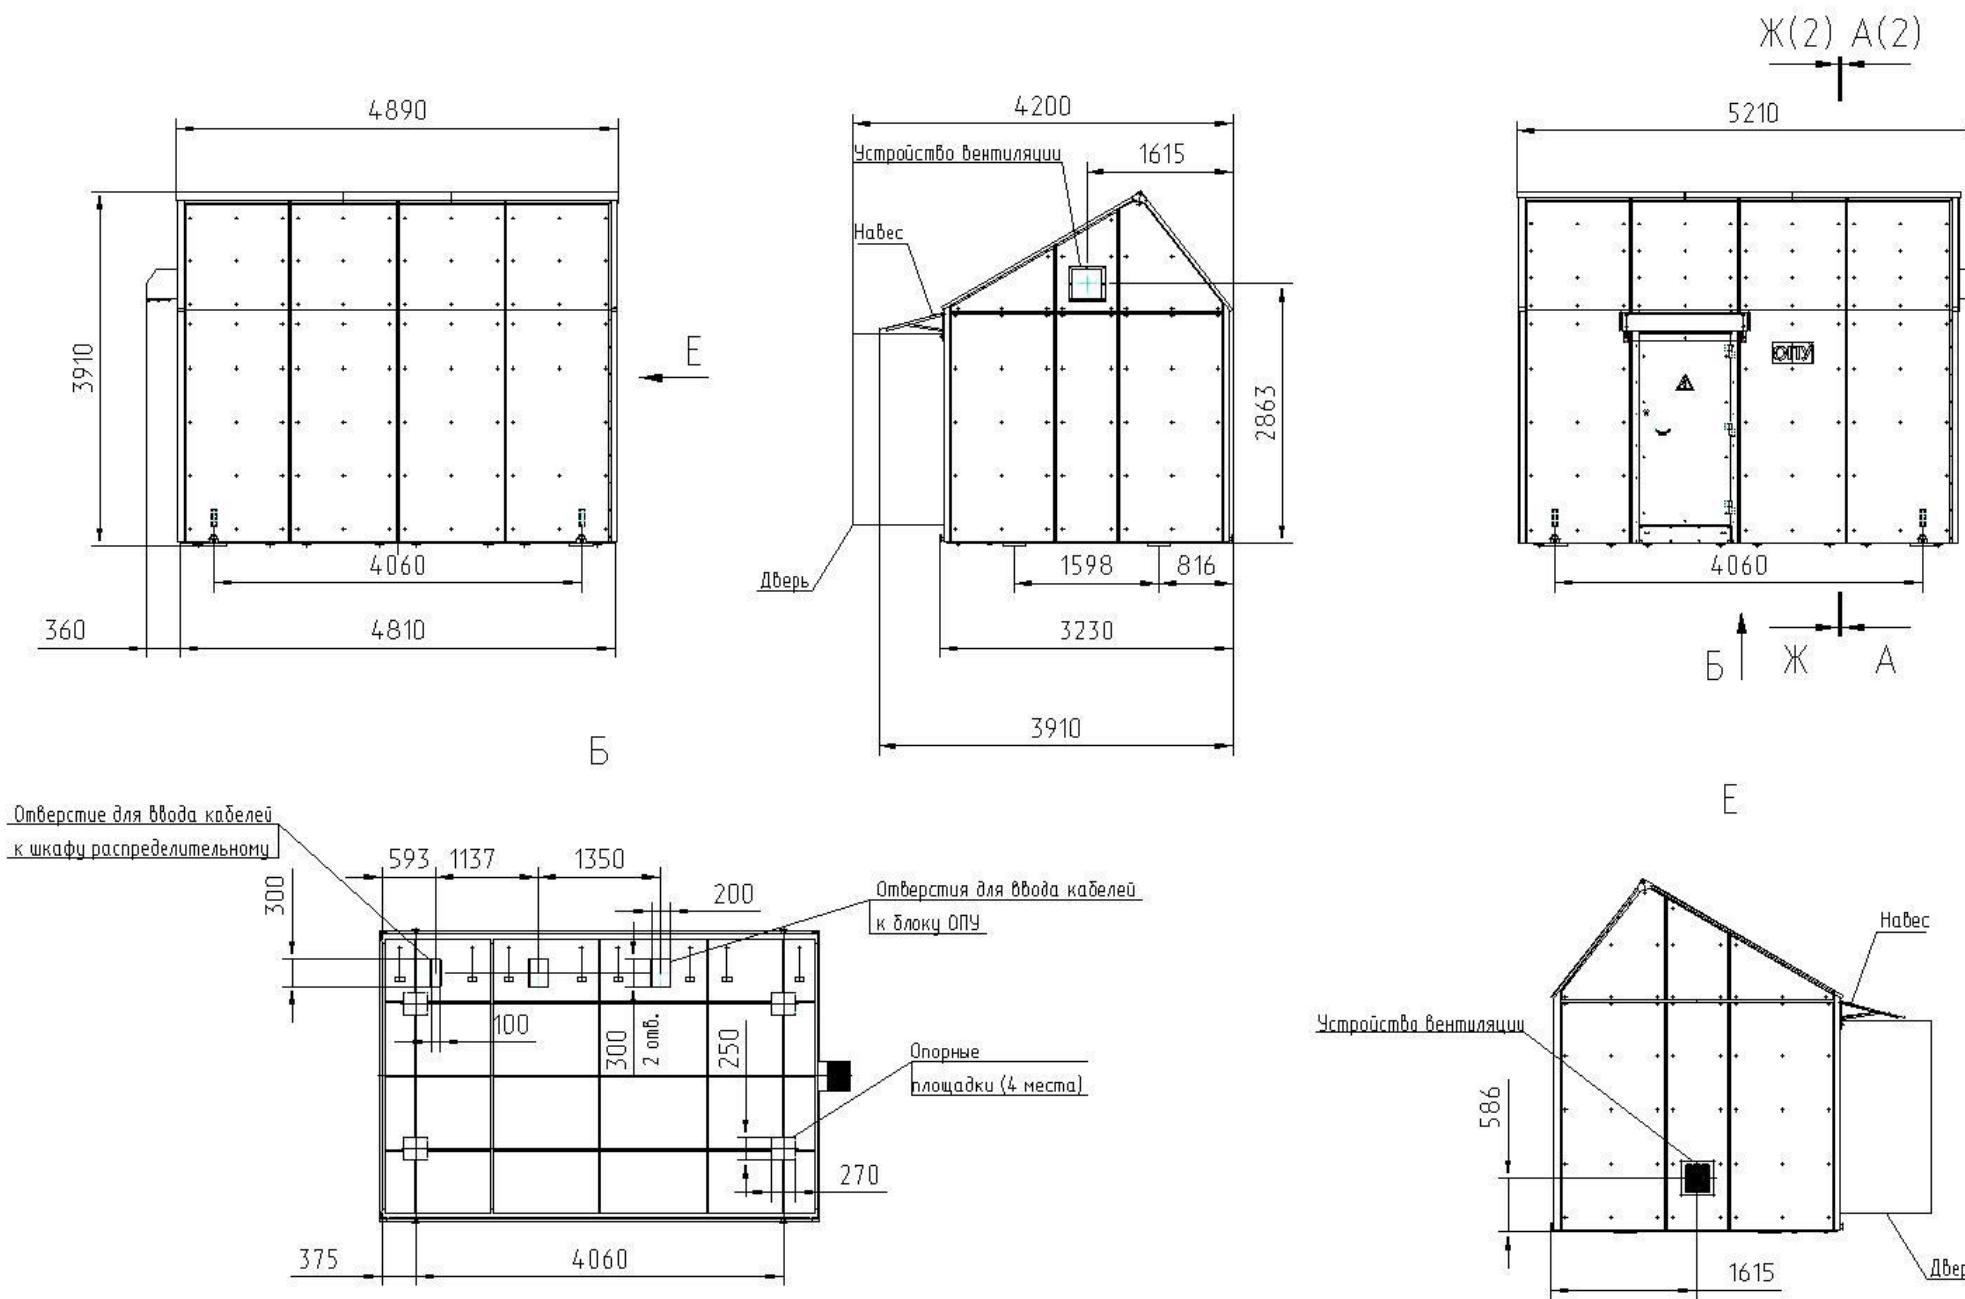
Габаритный чертеж модуля ОПУ типоразмером 4,8 м
